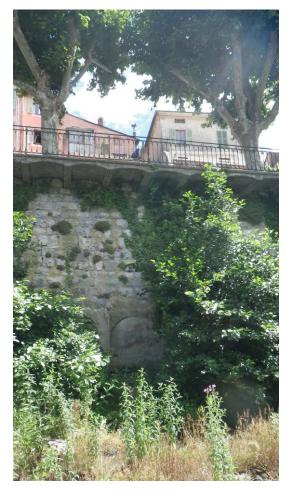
Seuil amont du canal Boéri, regard sous chaussée et canalisation EU verticale
